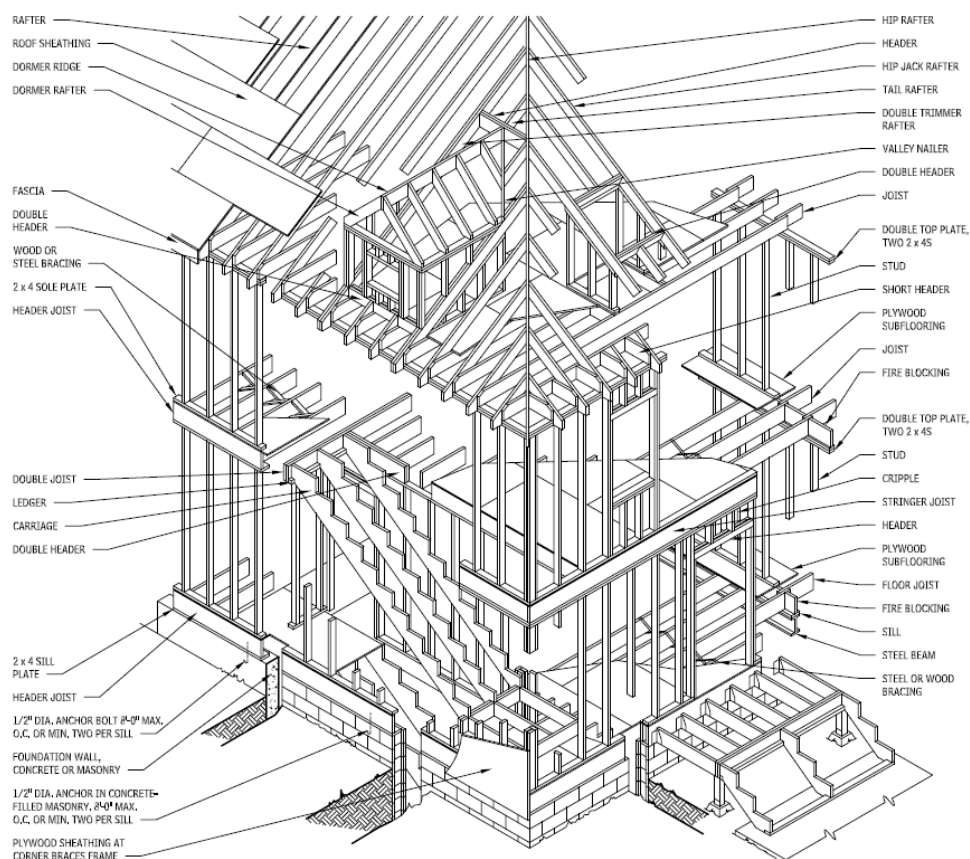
Axonometria do sistema *platform framing* (American Institute of Architects, 2008).
